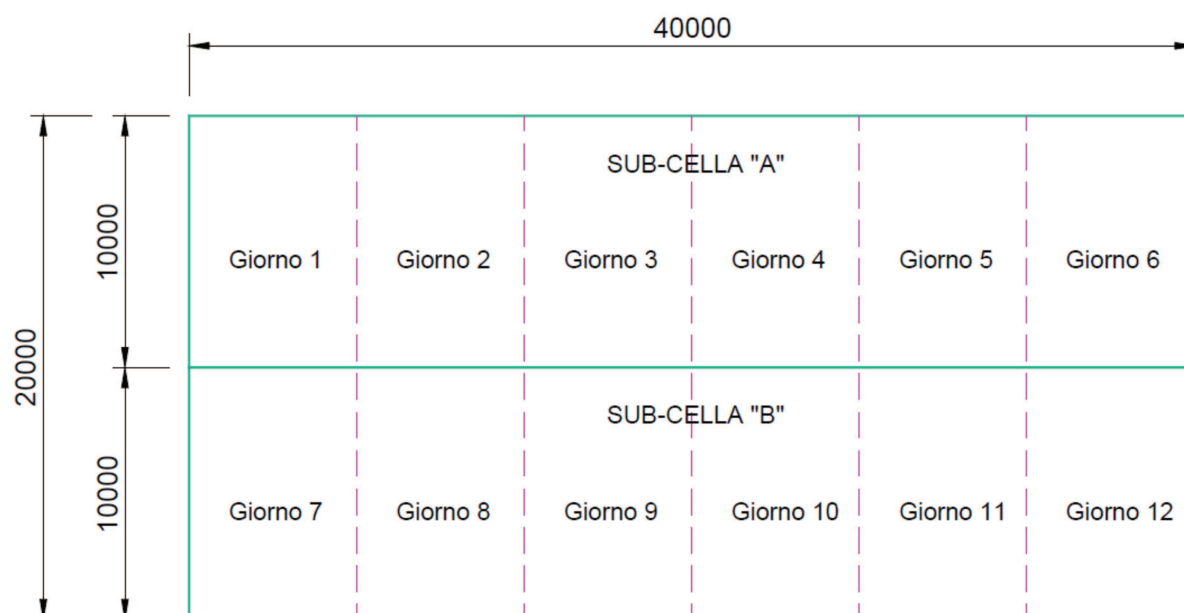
Planimetria coltivazione tipo con suddivisione giorni di conferimento
